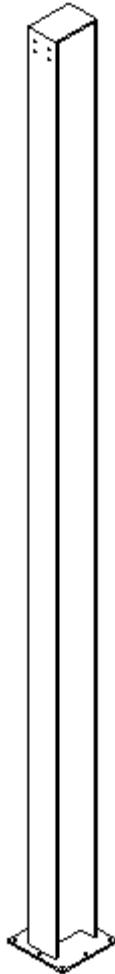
Pilars metàl·lics perfil HEB450 pels pilars que suporten una biga pinyó. (Font: "Revit")
